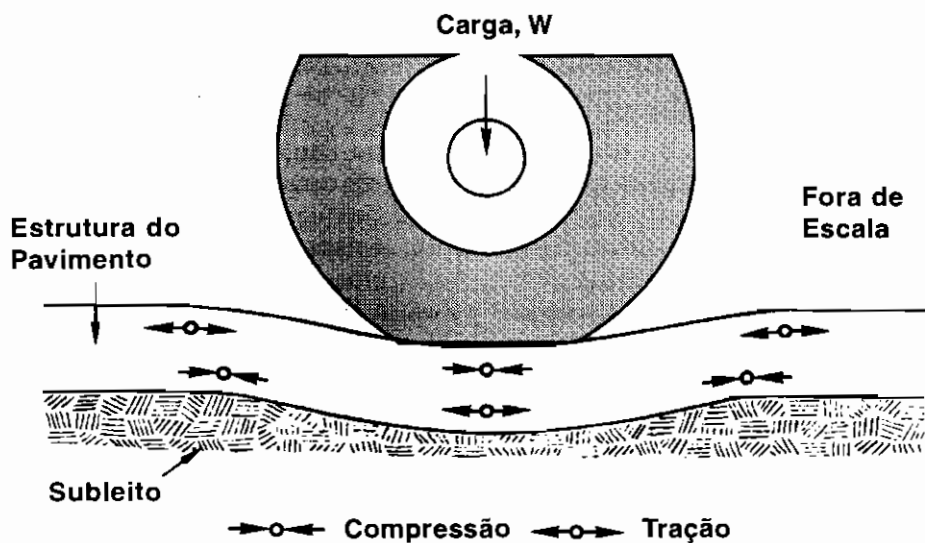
Resultados de Deflexões de Carga de Roda em Tensões de Tração e Compressão na Estrutura do Pavimento.
